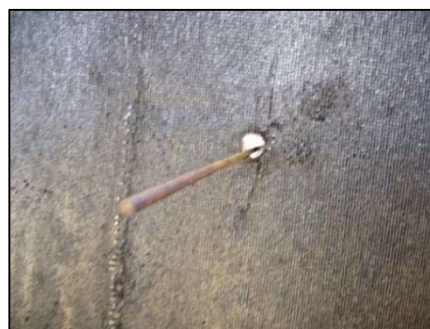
Vergalhão atravessando o furo para agulhas não tapado, para verificação do preenchimento do espaço vazio.
